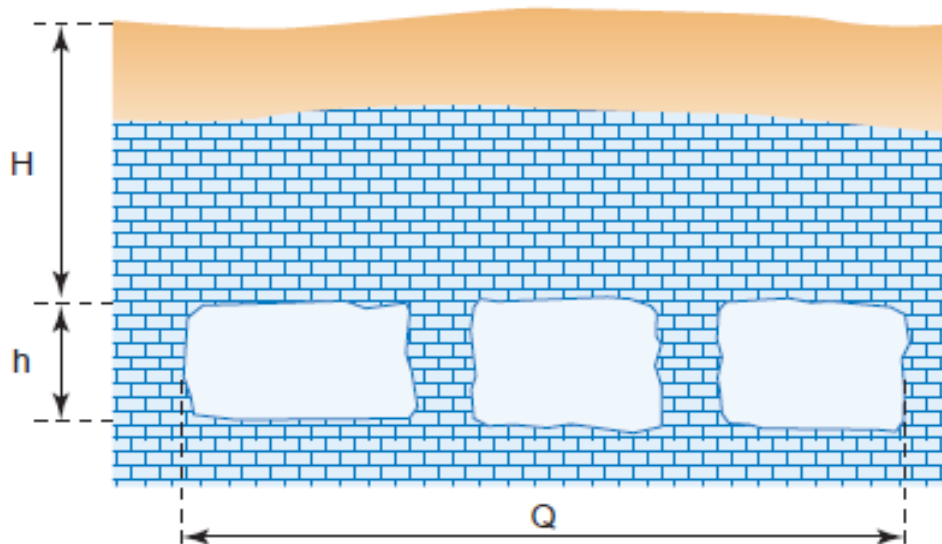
Dimensions types des carrières souterraines (Ifsttar, 2014).
